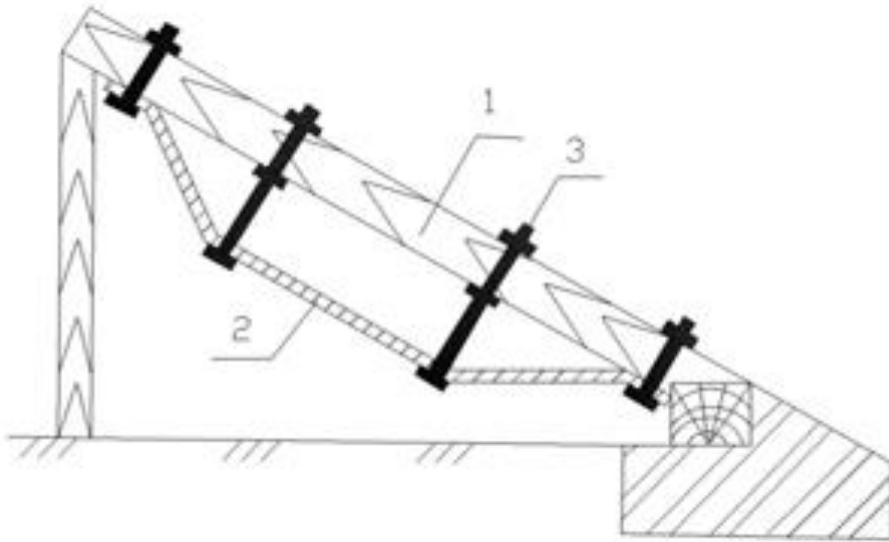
Схема усиления стропильной ноги стропильной фермы шпренгельной фермой:
